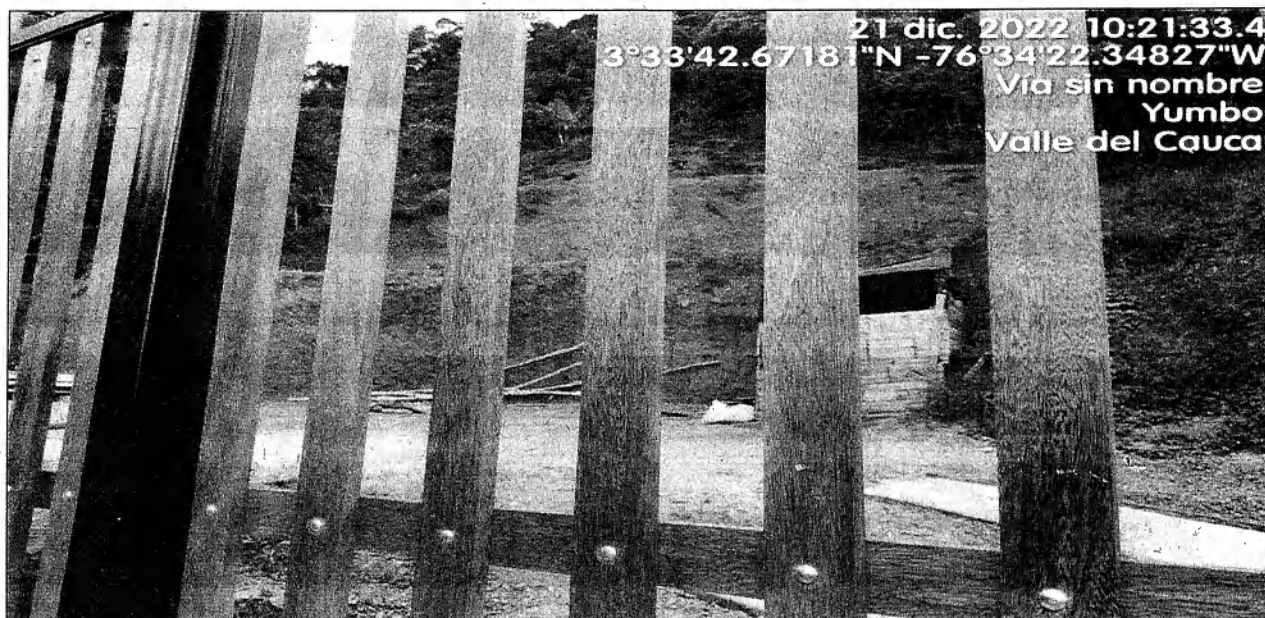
Vista interna del Lote Sin Nombre desde la puerta de acceso.
